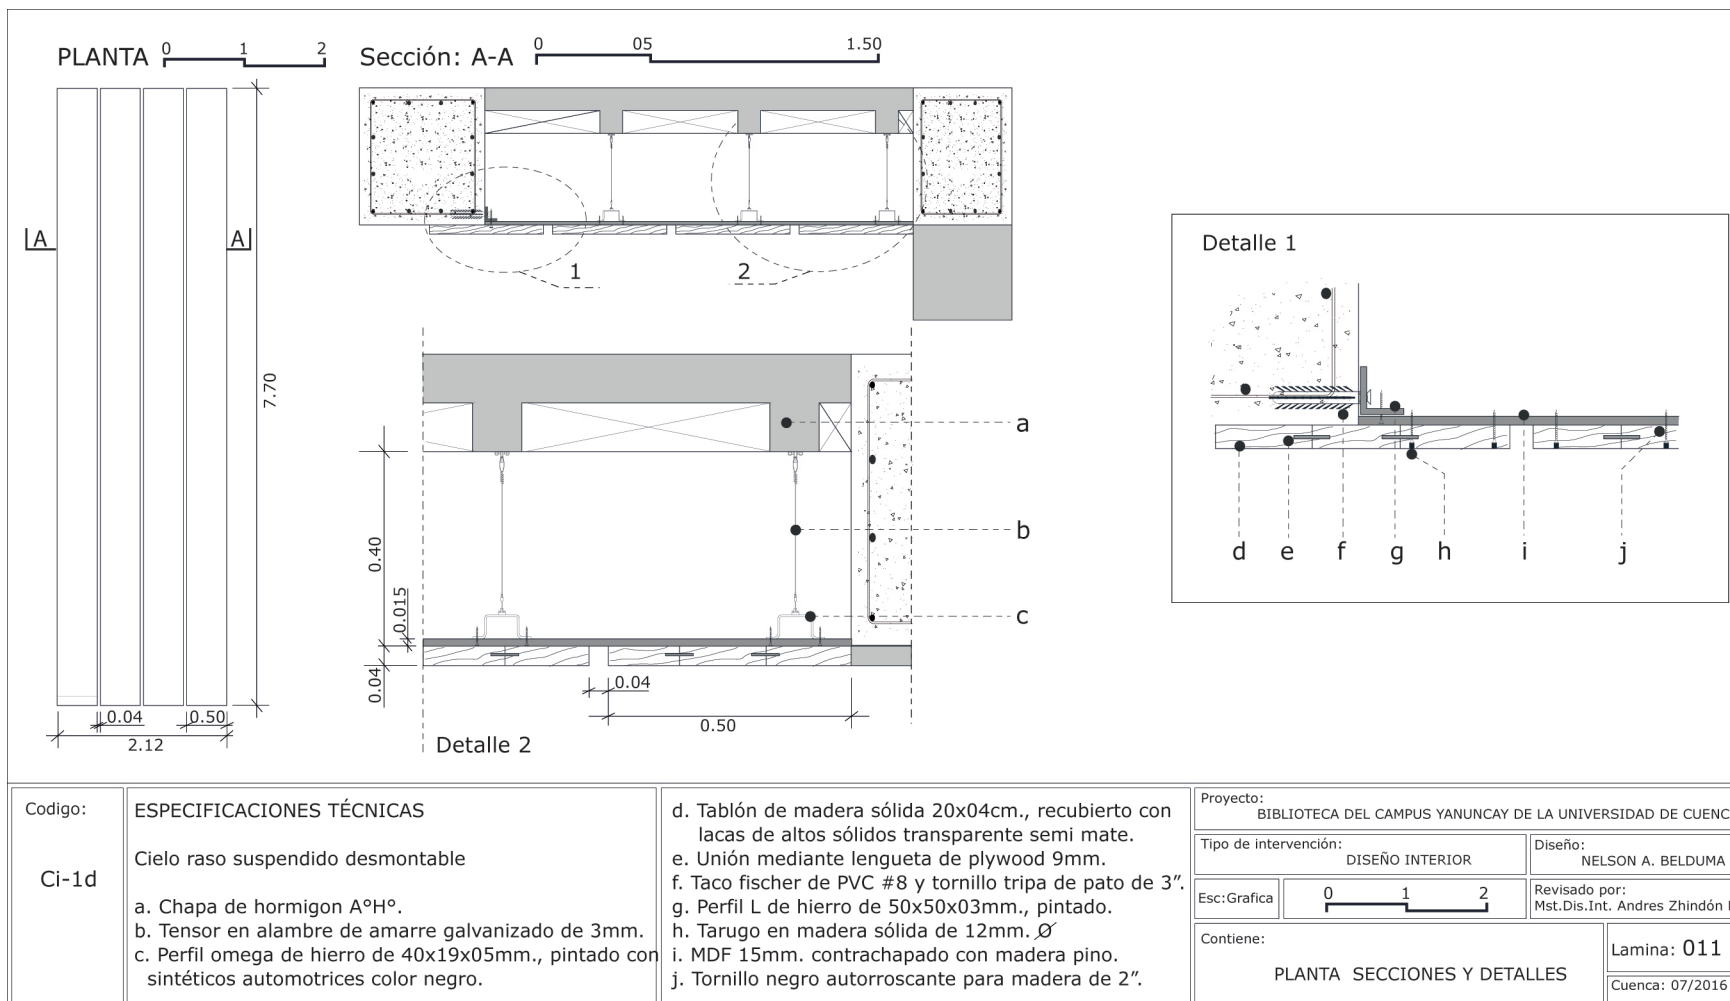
Planta, secciones y detalles. Espacio de reunión y descanso de los usuarios. Ci-1d.
